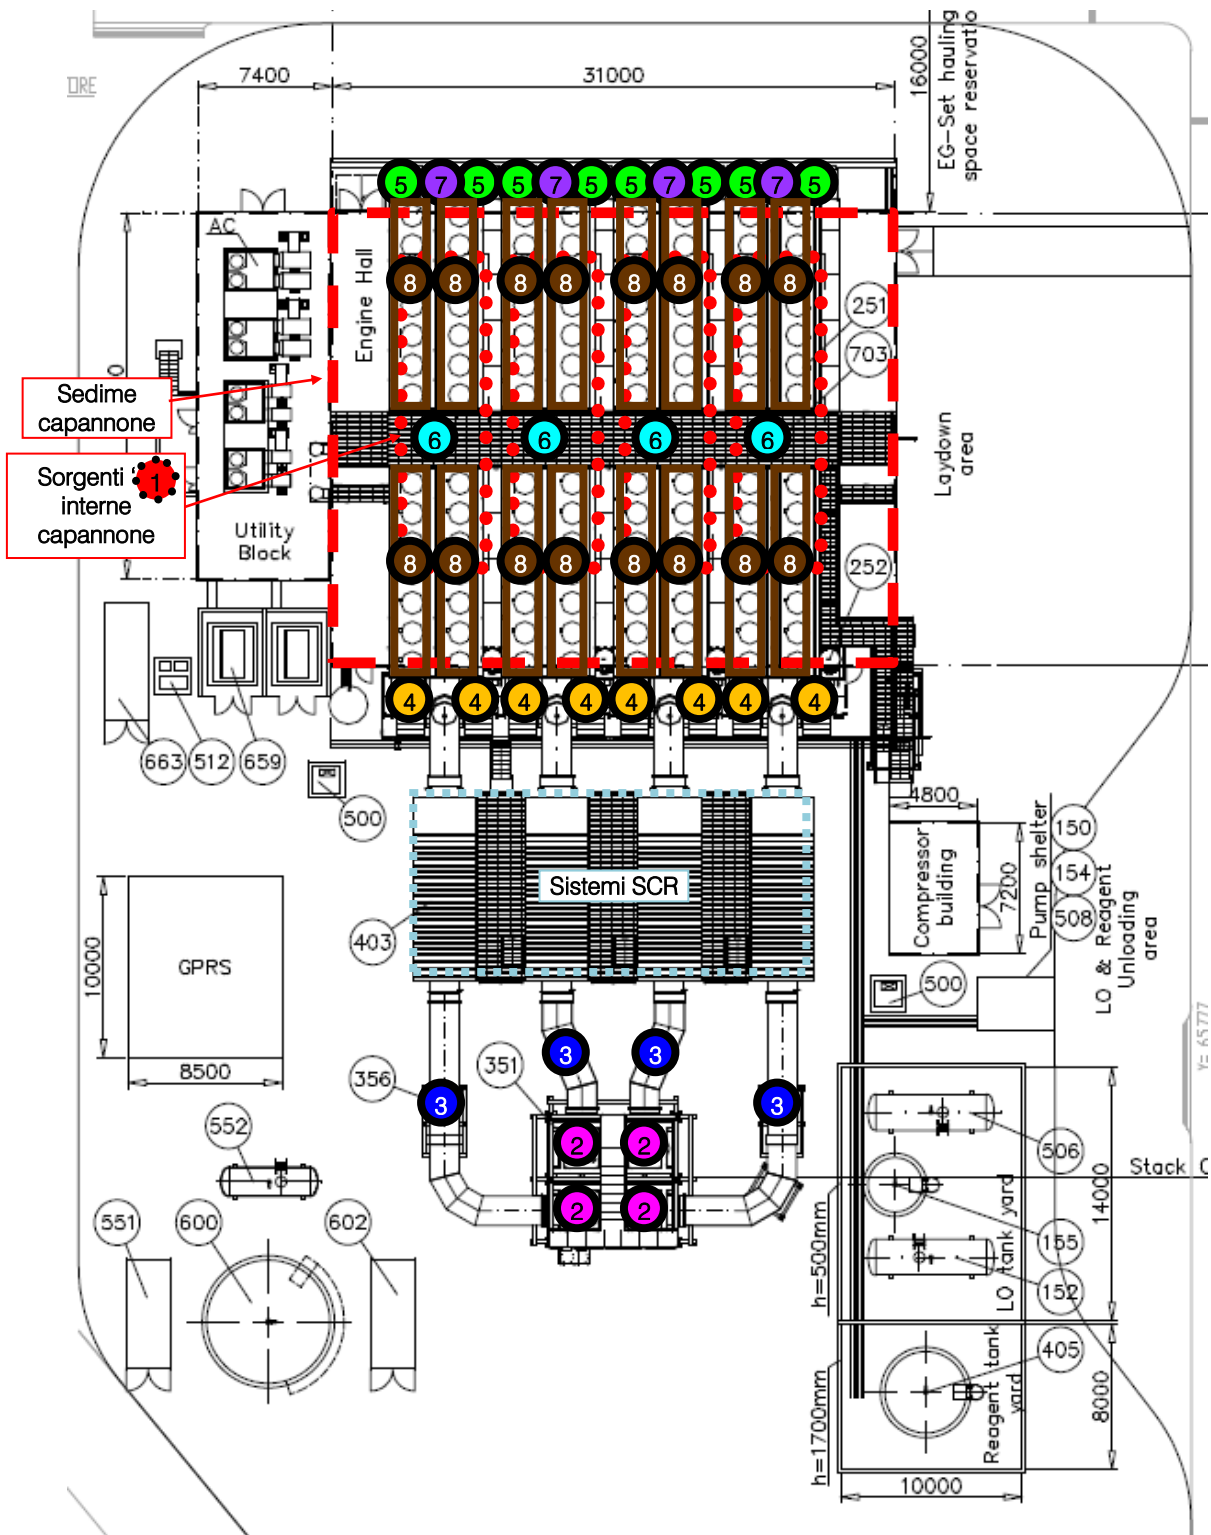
Planimetria della centrale in progetto con individuazione delle sorgenti sonore.
